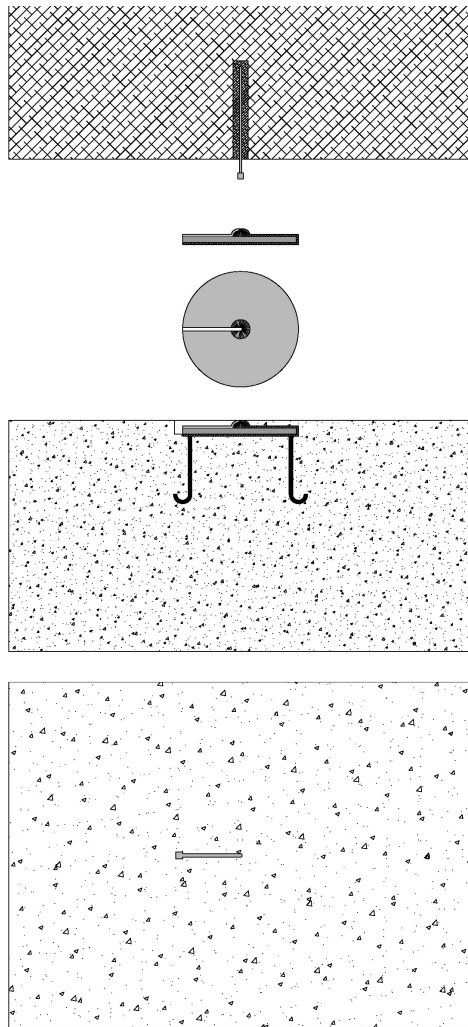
78 – Ancoraggio dell'isolatore alla platea di fondazione mediante un cavetto in acciaio, vulcanizzato nell'isolatore e fissato ad una piastra in acciaio secondo il *brake cycles system*.
